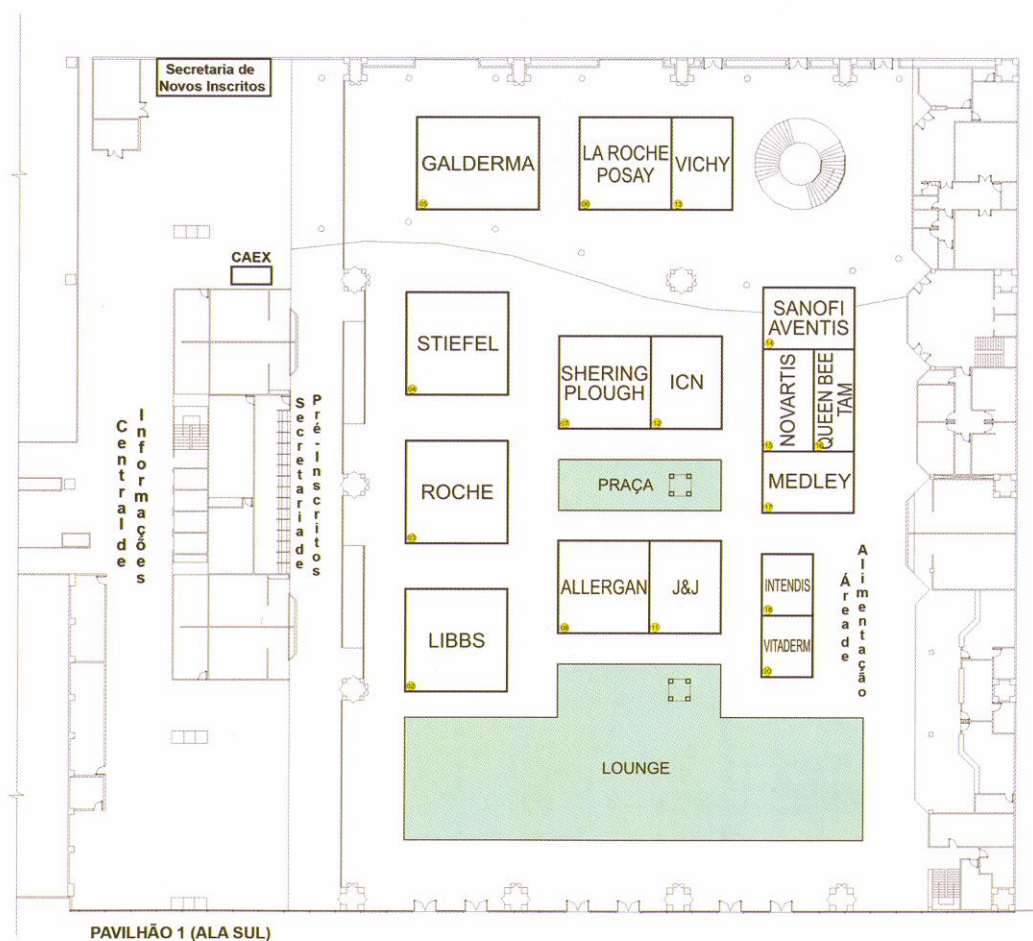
Planta Baixa 1º Pavimento - Novo Centro de Convenções
